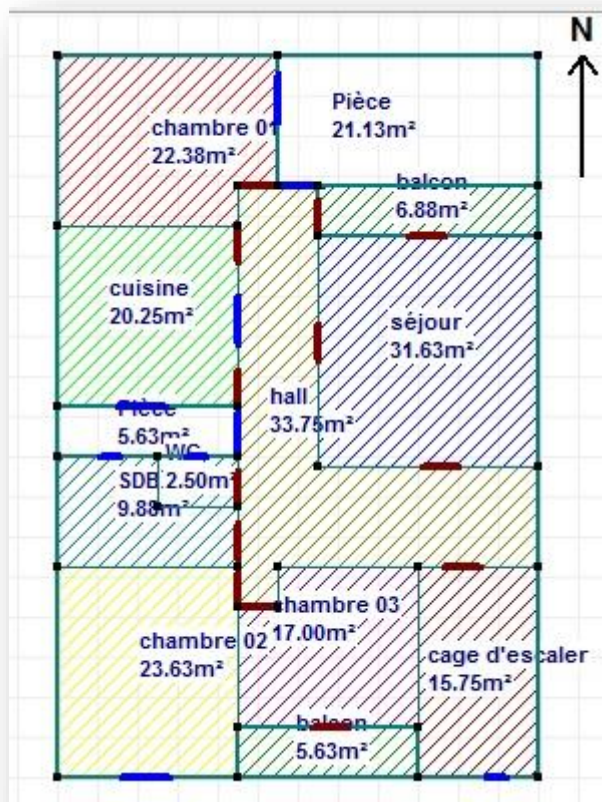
; plan du cas etudier sous pleiade 2.3
